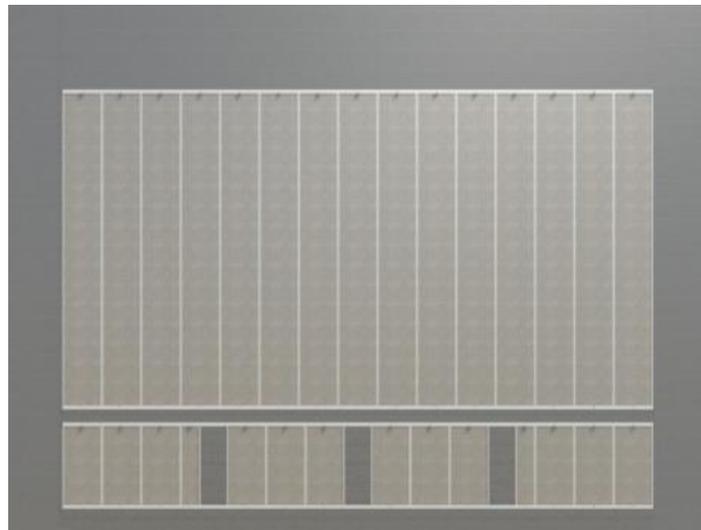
蒸压砂加气混凝土 (ALC) 板材超高外墙拼接施工工法完成效果
